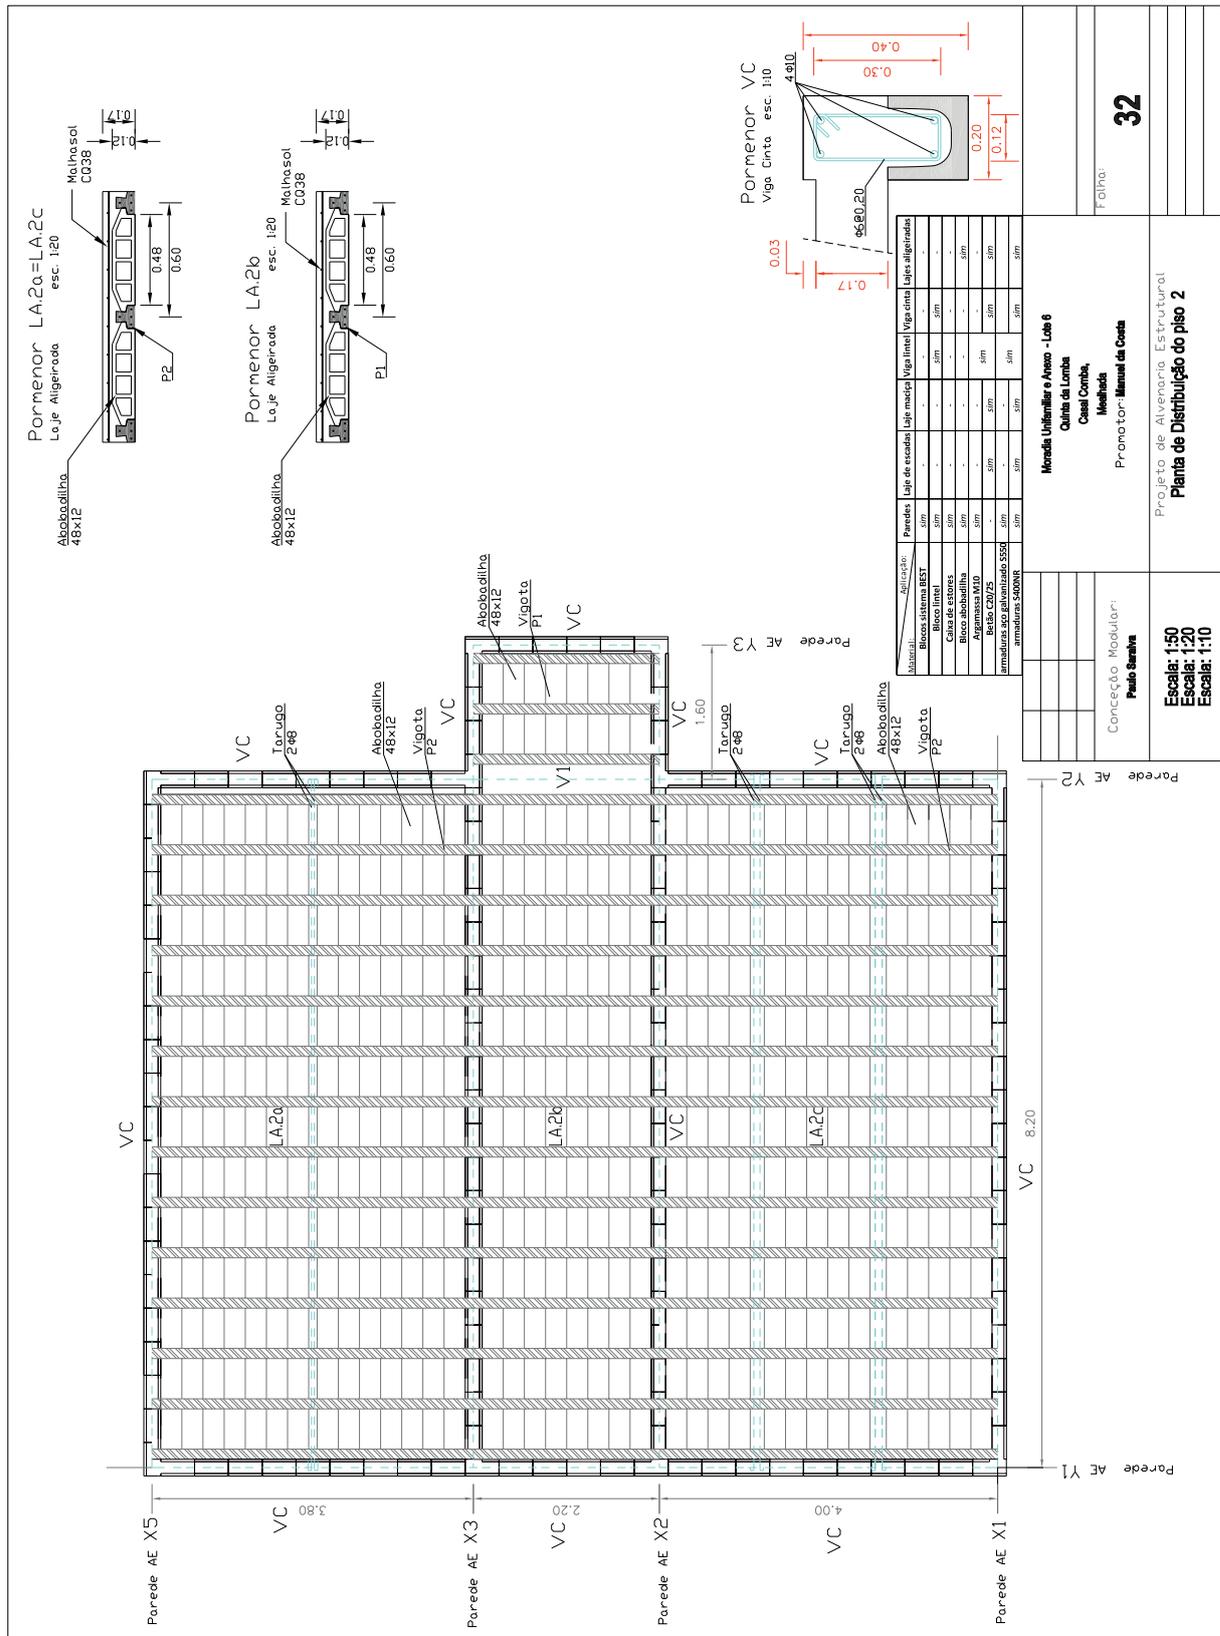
Planta da laje do teto do 1º piso da solução em AE
